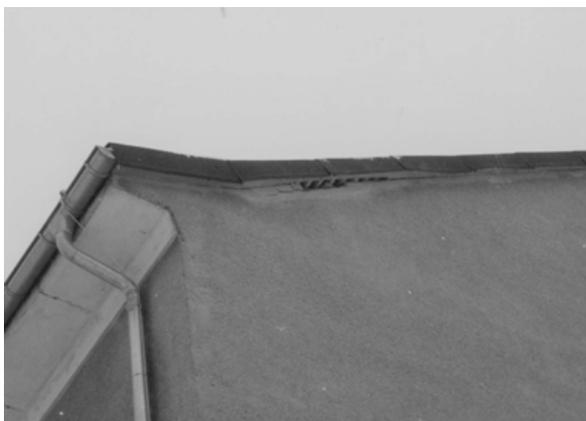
Schadensbild der seitlich ausgewichenen Nagelbrettbinder des Otto-Meisser-Baus
